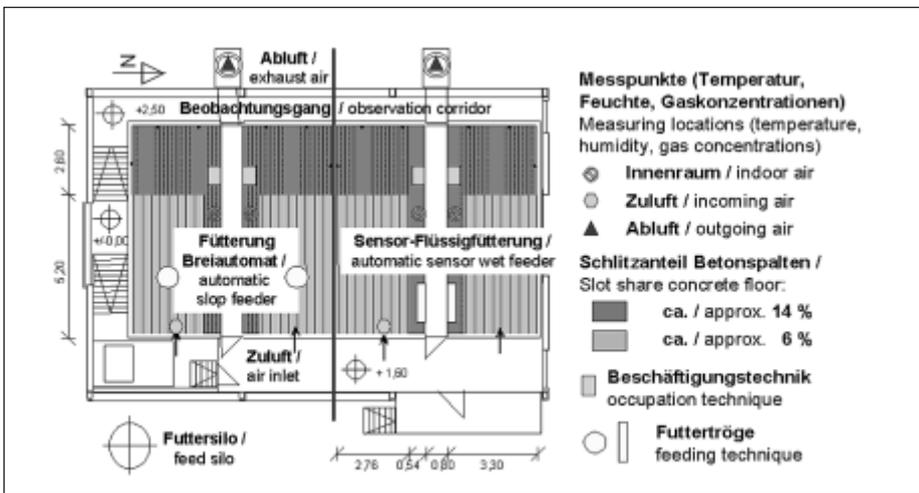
Grundriss des Hohenheimer Versuchsstalles für Mastschweine
